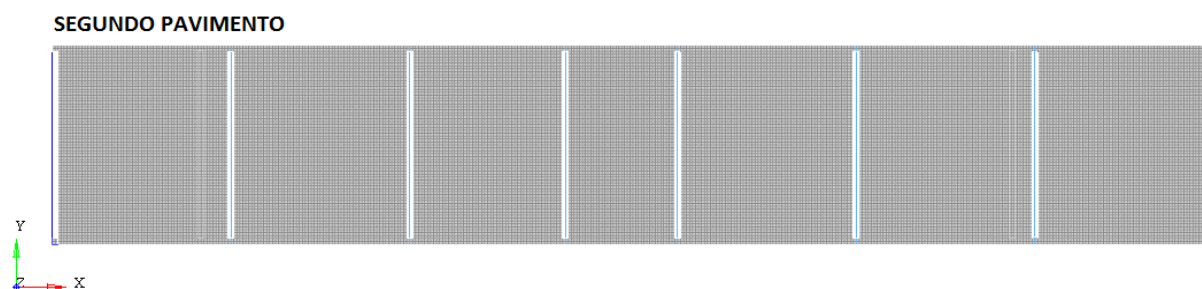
Malha de aço adicionada embaixo das lajes do segundo pavimento
